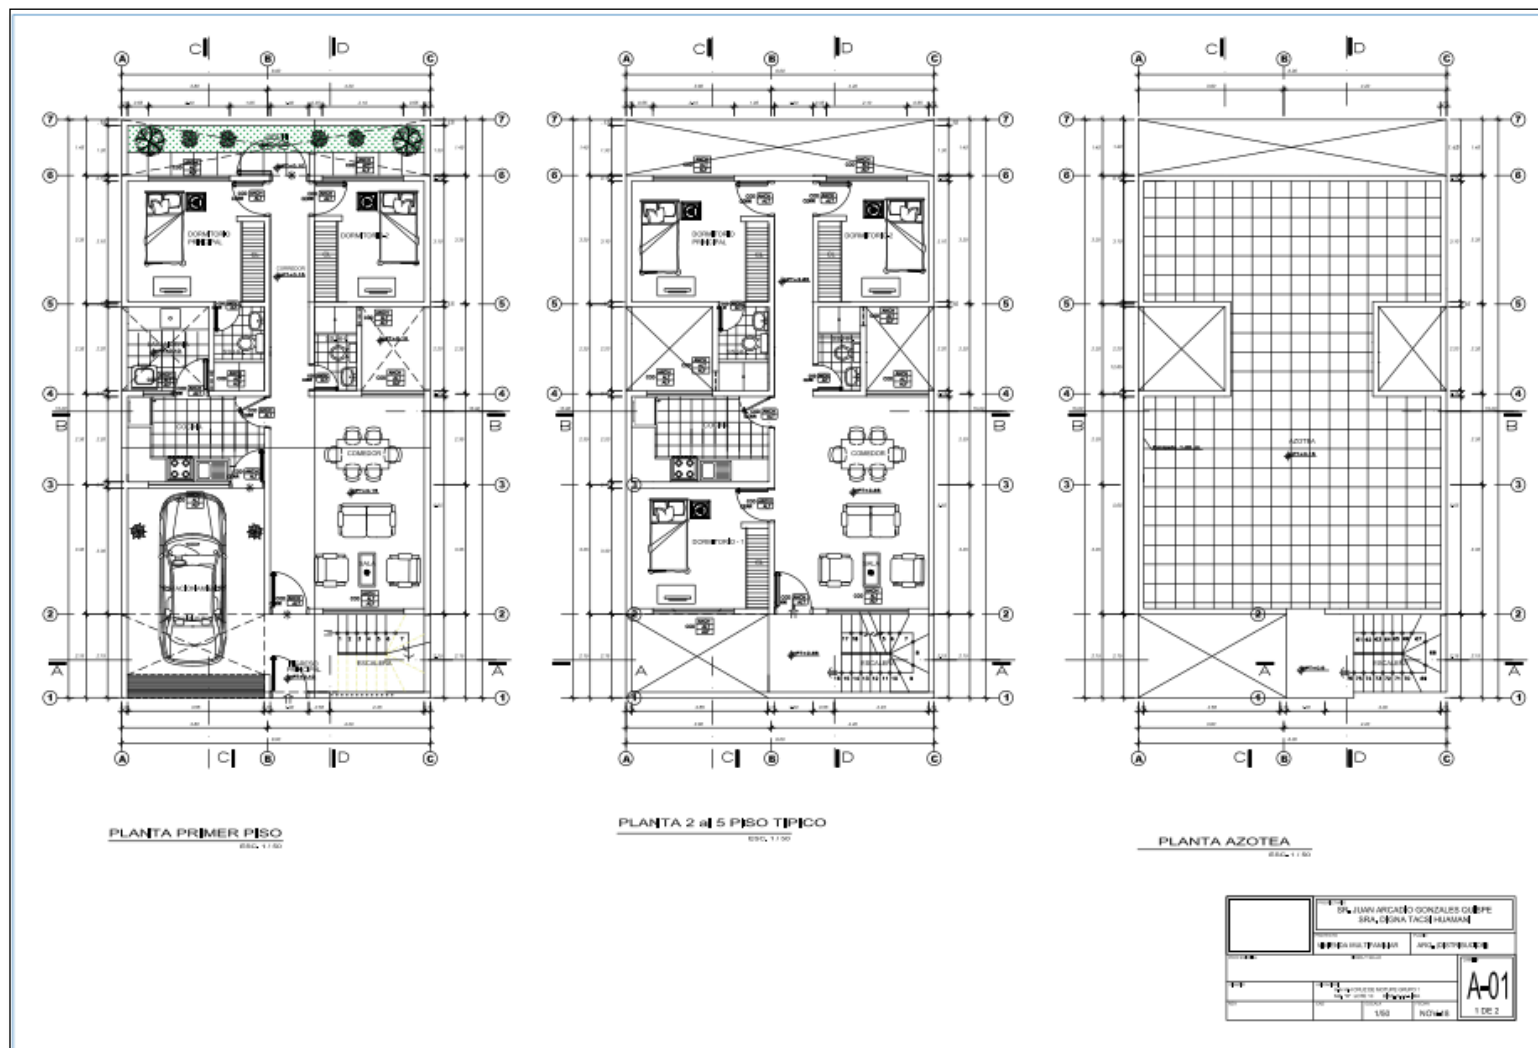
Plano de distribución en planta del proyecto de vivienda multifamiliar. Elaboración propia.
